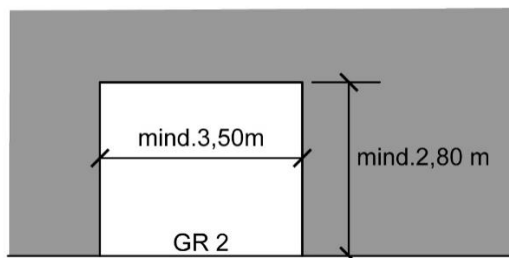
Schema- Längsschnitt durch südlichen Gebäudeteil in Baufeld B (Gehrecht 2).
